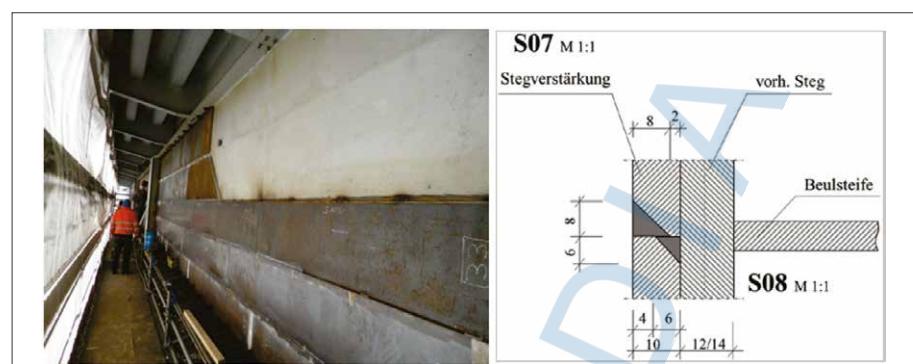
Anbringen von Verstärkungsplatten am Längsträger (links) und konzipierte Nahtvariante zur Stegverstärkung (rechts) als ein Beispiel für schweißtechnische Ertüchtigungsmaßnahmen.
